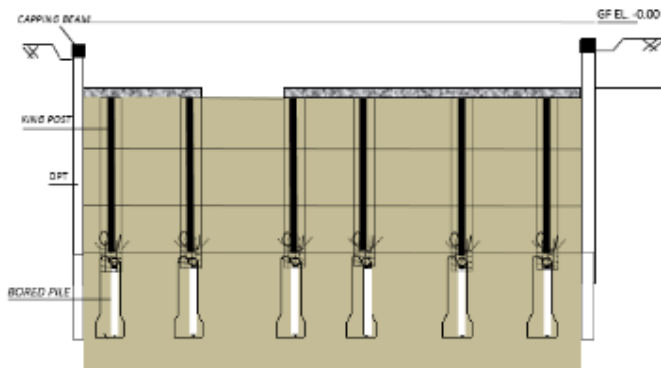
Konstruksi *Bored Pile* dan *King Post
